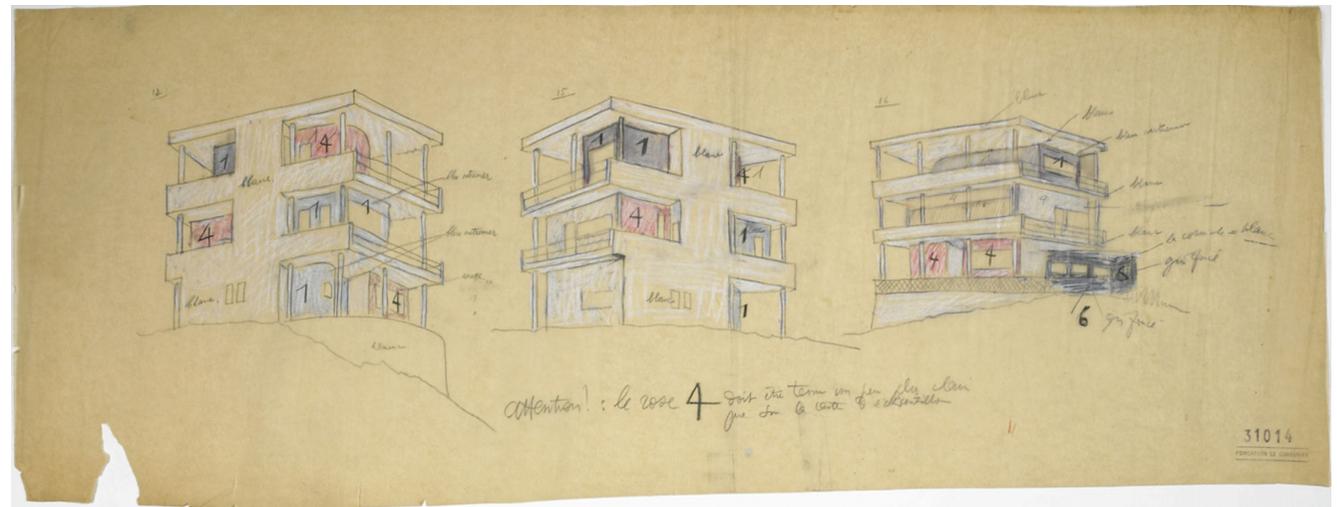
planos de © FLC/ADAGP. Villa Baizeu (24931)
